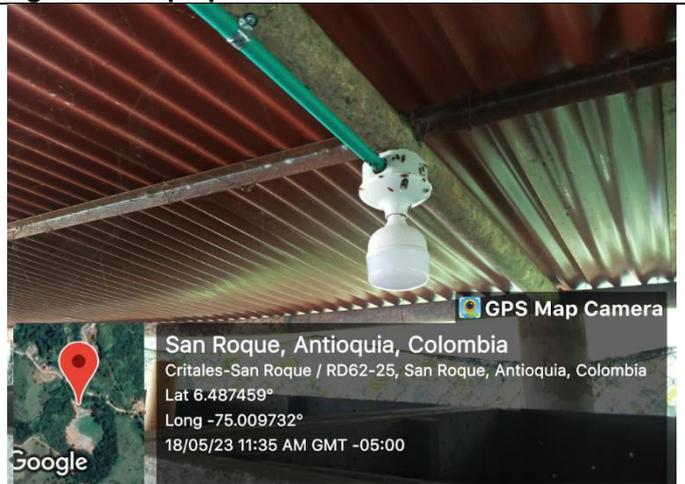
Planta de tratamiento – cajas de compostaje
